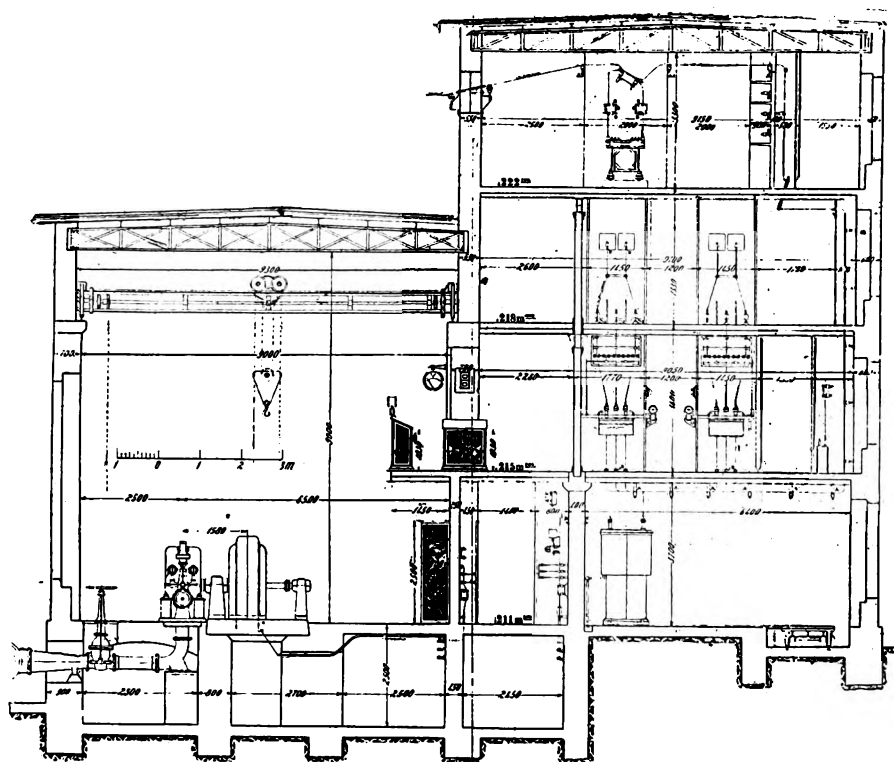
Coupe transversale de l'usine hydraulique de la Verzasca.
